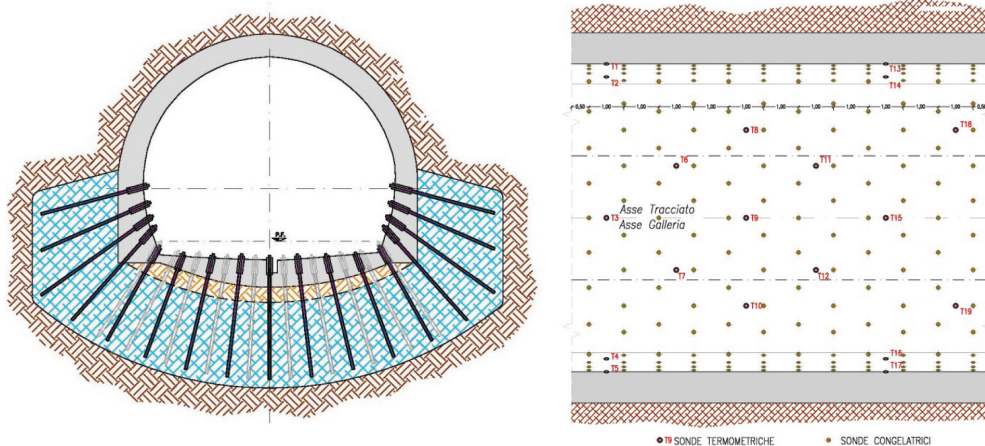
Schema geometrico di installazione delle sonde congelatrici: sezione trasversale e vista planimetrica. Freeze pipes lay-out in the tunnel cross-section and plan view.
